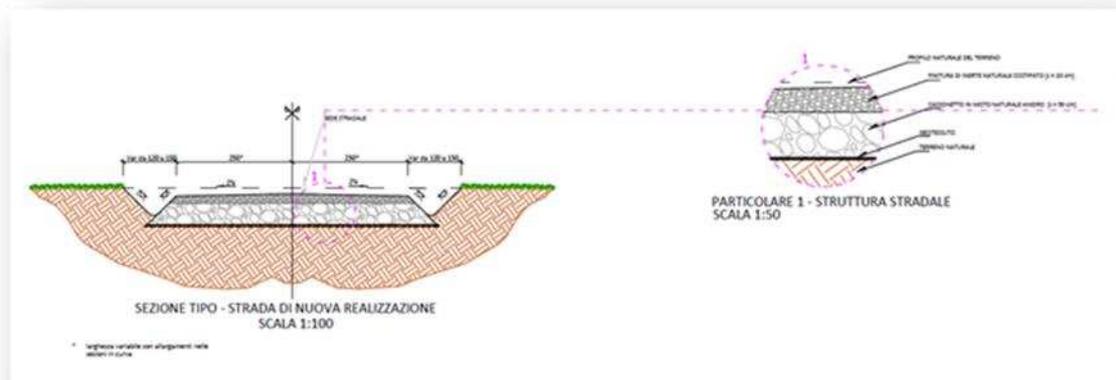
Estratto elaborato EDP0055 (Sezione stradali tipo e viabilità)
